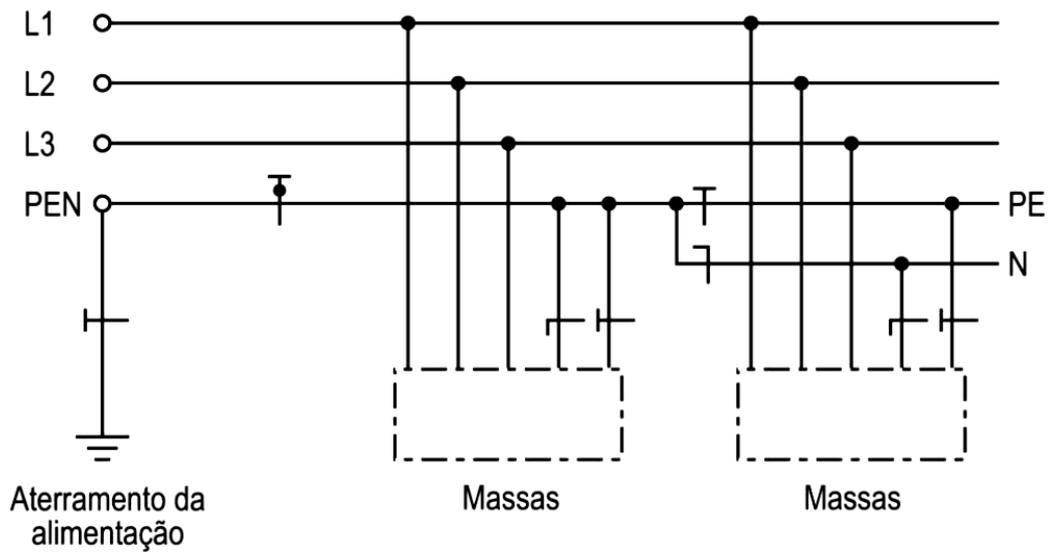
TN-C-S — condutores neutro e de proteção separados em parte da instalação [NBR 5410]
